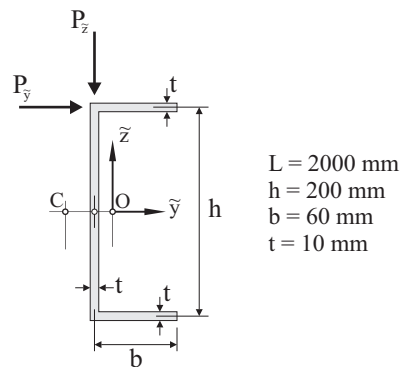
Viga con sección *C*, con dos cargas puntuales en el otro.
